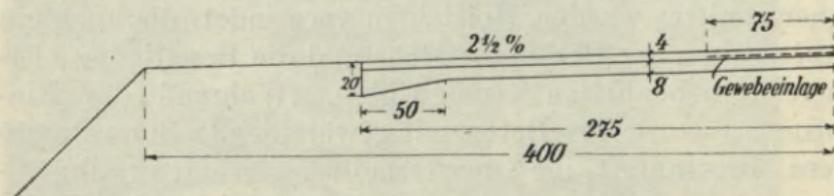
Betonstraße München-Ingolstadt bei Neuherberg. Querschnitt.
